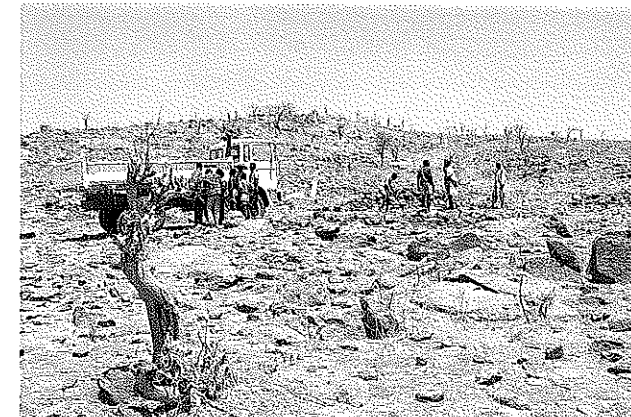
Construction d'une digue filtrante par les hommes et par les femmes.
